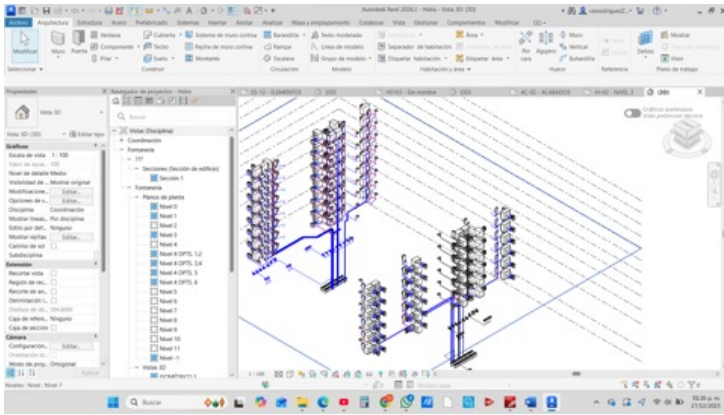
Vista General Proyecto de Sanchez Argüelles Roberto
